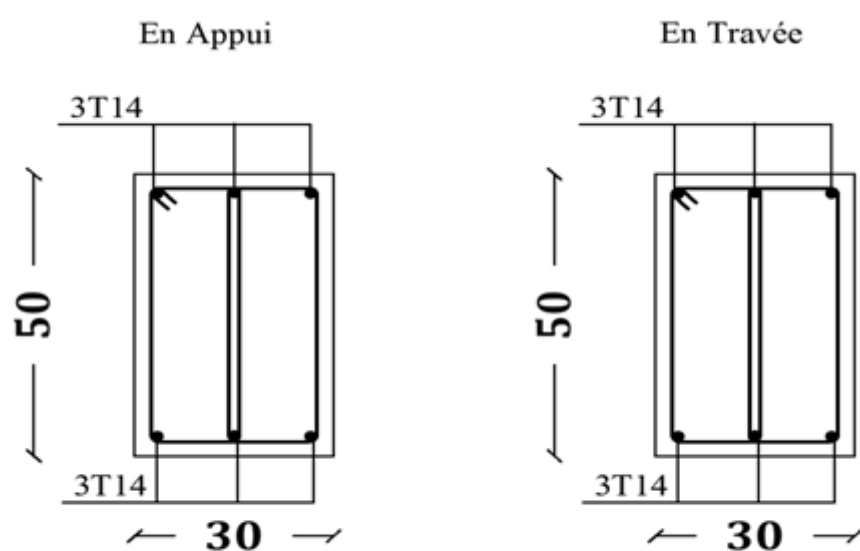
ferrailage de poutre RDC et Terrasse (30*50cm²).
